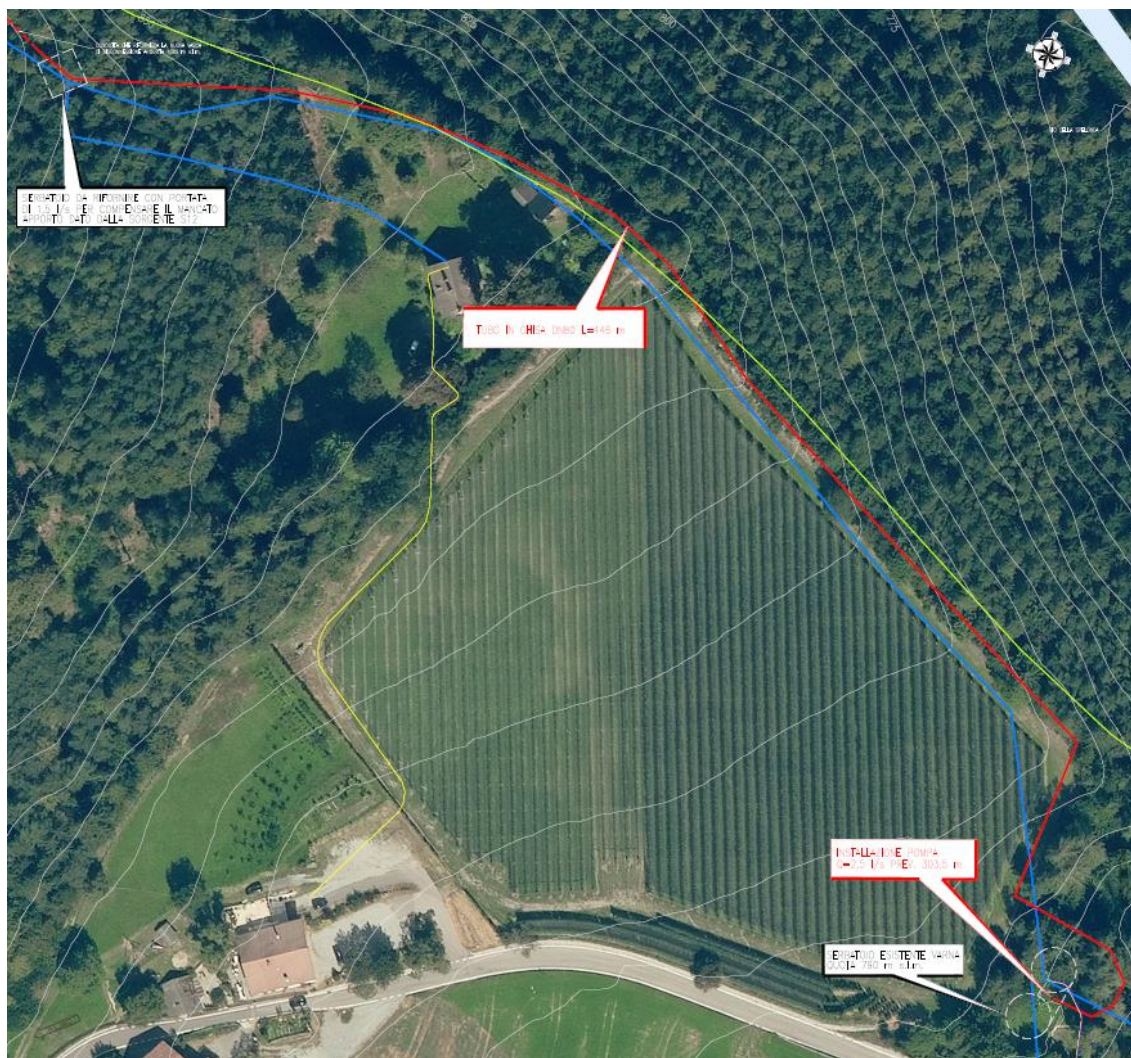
Estratto planimetria sottoservizi sorgente S12
